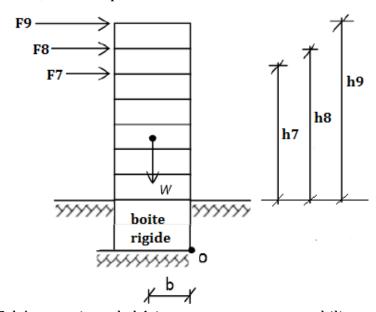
Schéma statique de bâtiment sous moments stabilisant et renversant.
